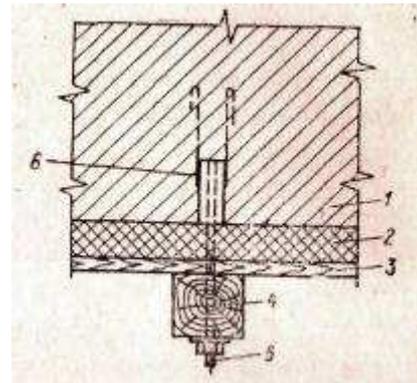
Схема устройства сменяемого анкерного крепления теплогидроизоляционного экрана (к п. 3.38)
